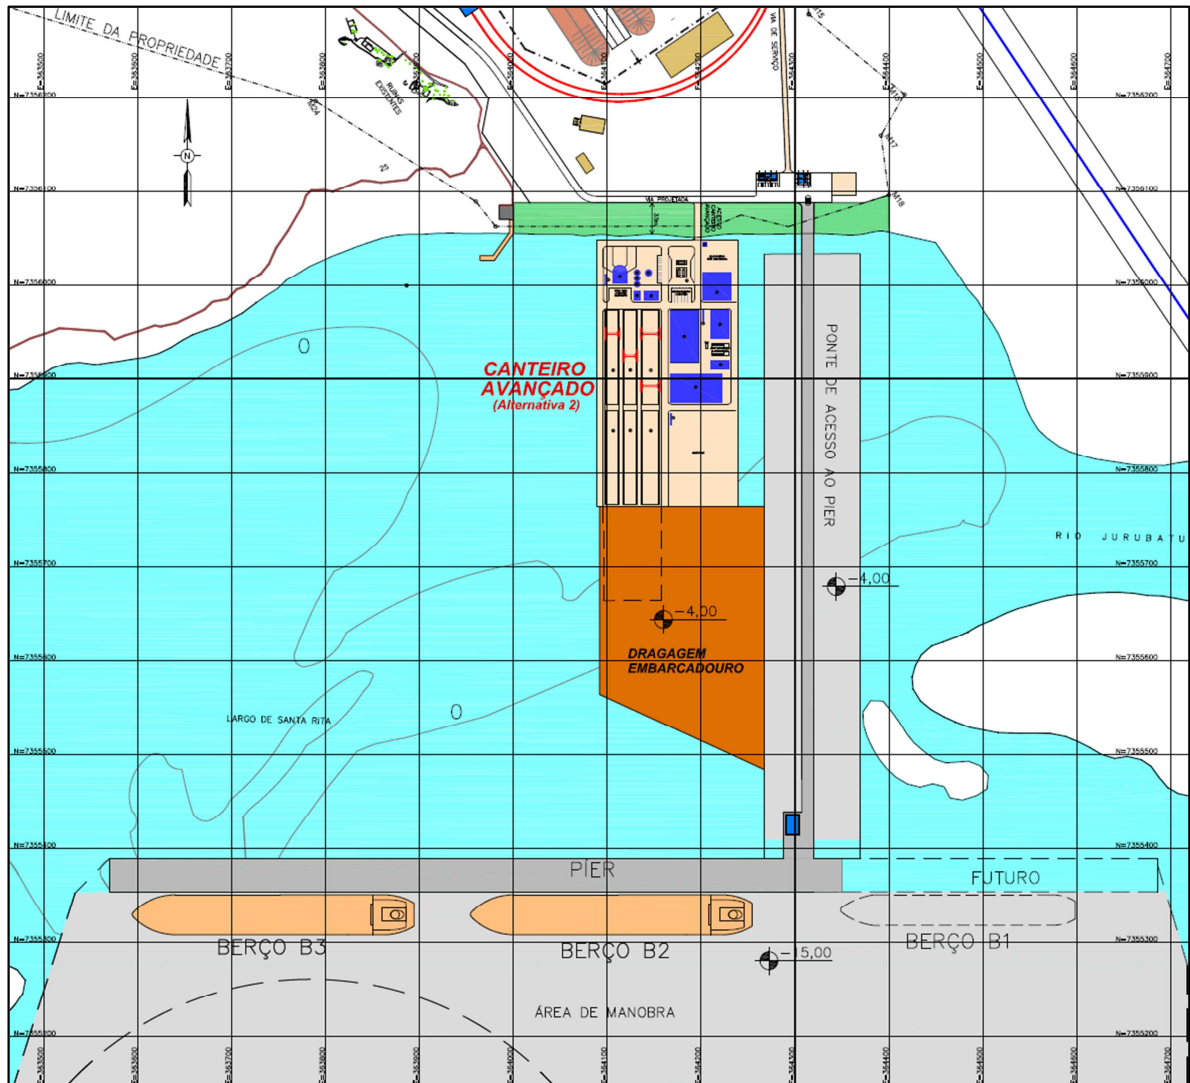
Projeto Conceitual de Dragagem – Canteiro Avançado – Alternativa 2 [9].
